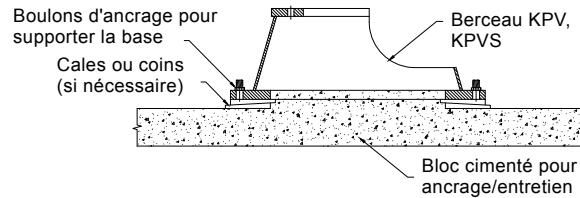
Installation du boulon d'ancrage KPV, KPVS
